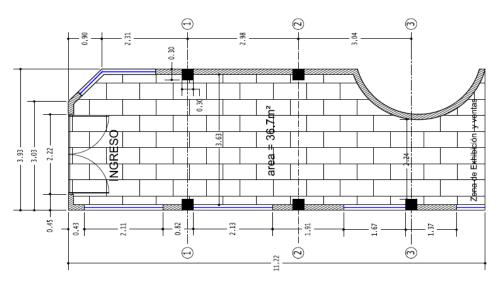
Planta arquitectónica de espacio propuesto para diseño interior con vegetación. Fuente: (Cevallos, 2014)
